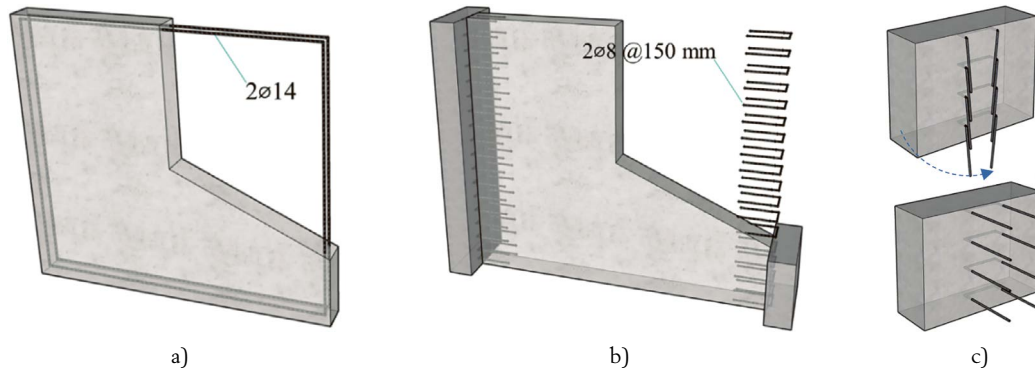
Disposiciones preliminares de armadura estudiadas: (a) L1, disposición de la armadura perimetral; (b) L2, disposición de las cajas de conexión; (c) detalle del sistema de cajas de conexión.
